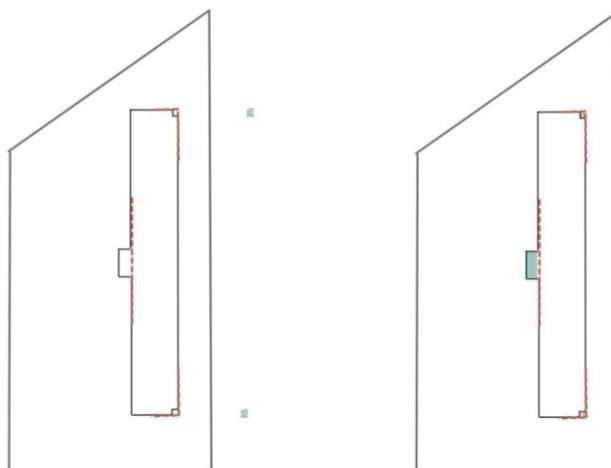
Edifício Cristalle - implantação - subtrações em cinza e adições em azul na planta. Fonte: Adrião, 2024.
